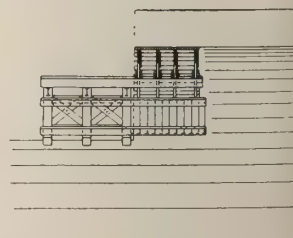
Überführung der Kölner Straße in Elberfeld. Bauwerk während des Umbaues
